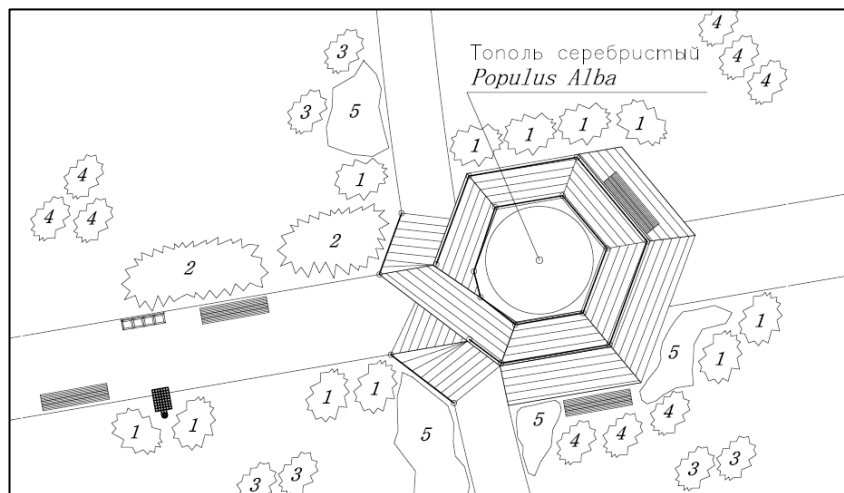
Фрагмент генплана 13, схема посадки растений для зоны смотровой площадки
